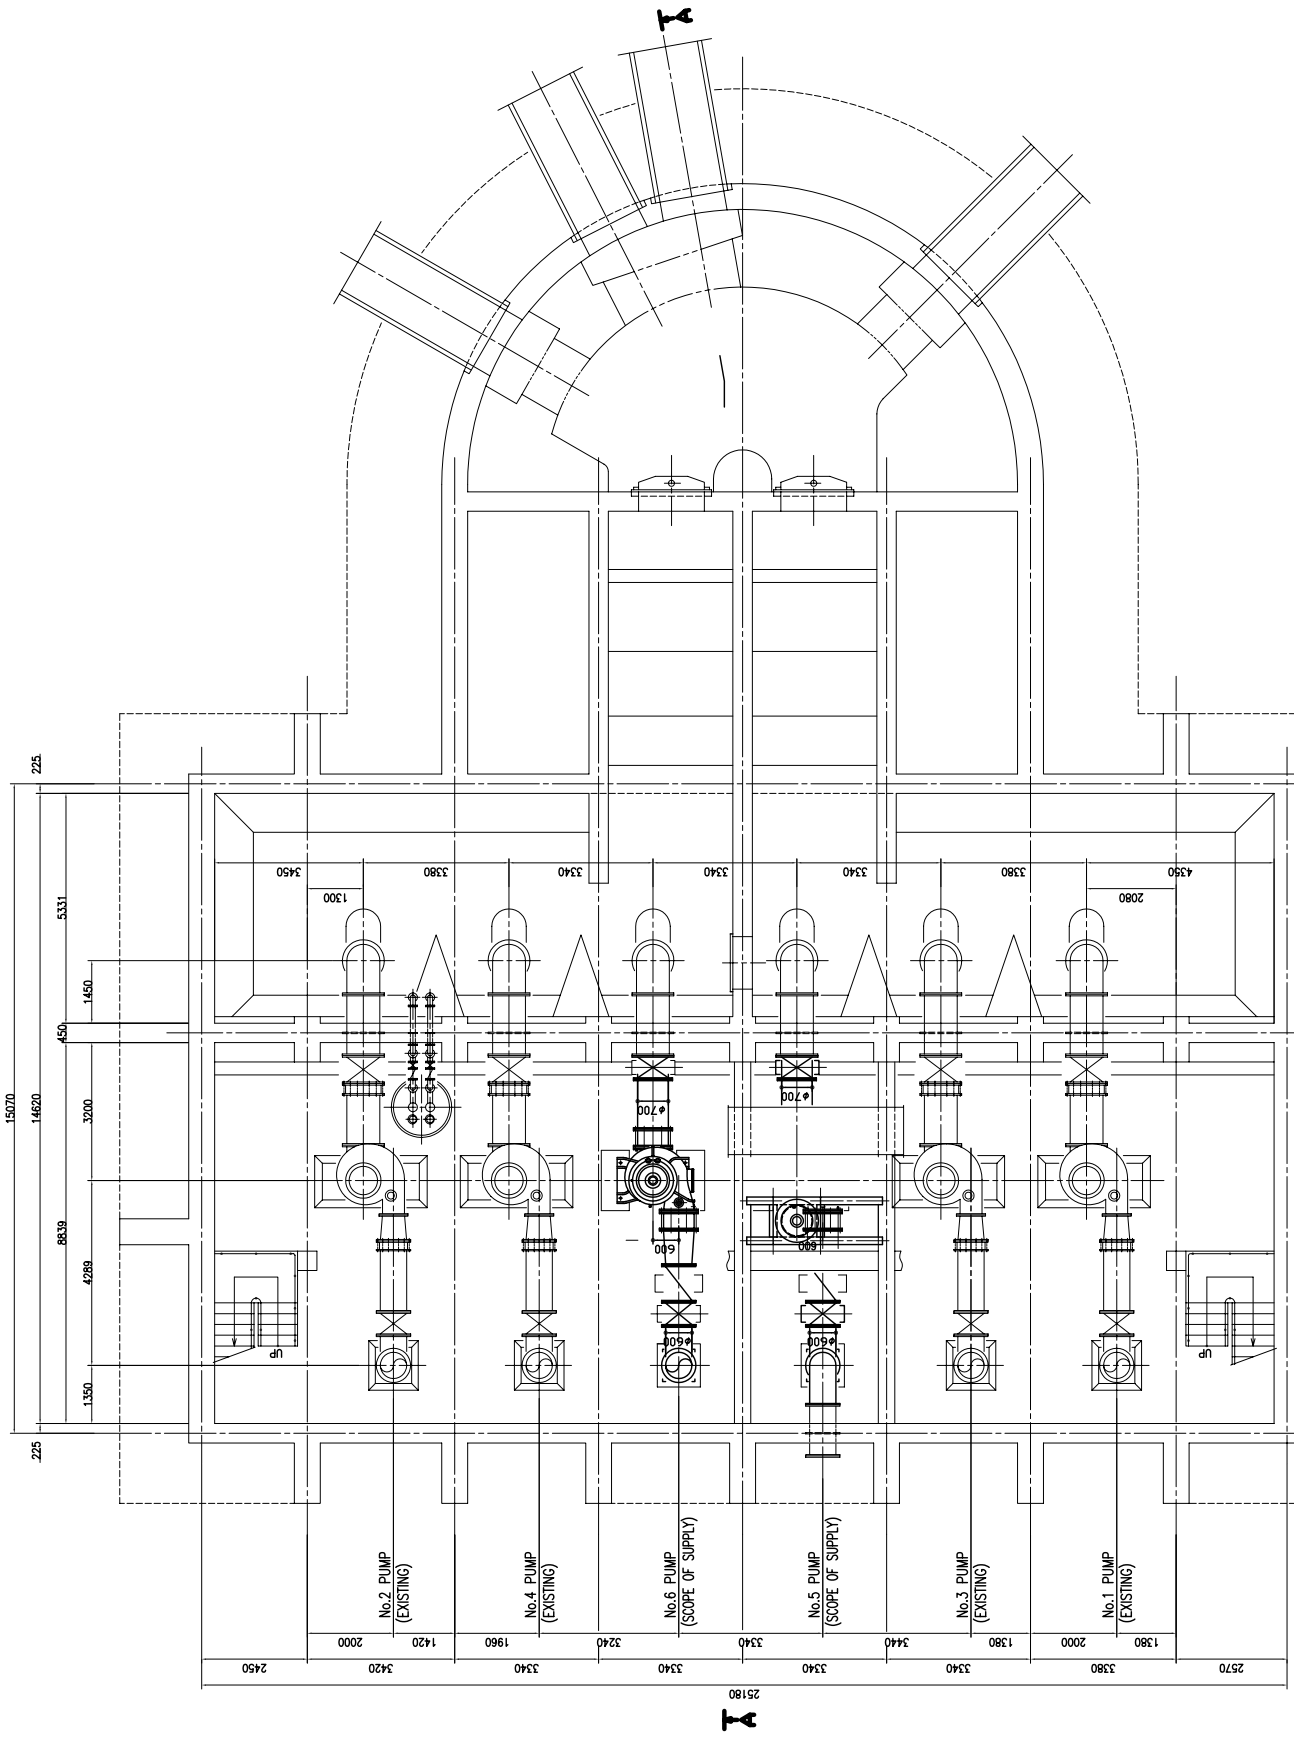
Shad Bagh ポンプ場平面図 (1/2)
